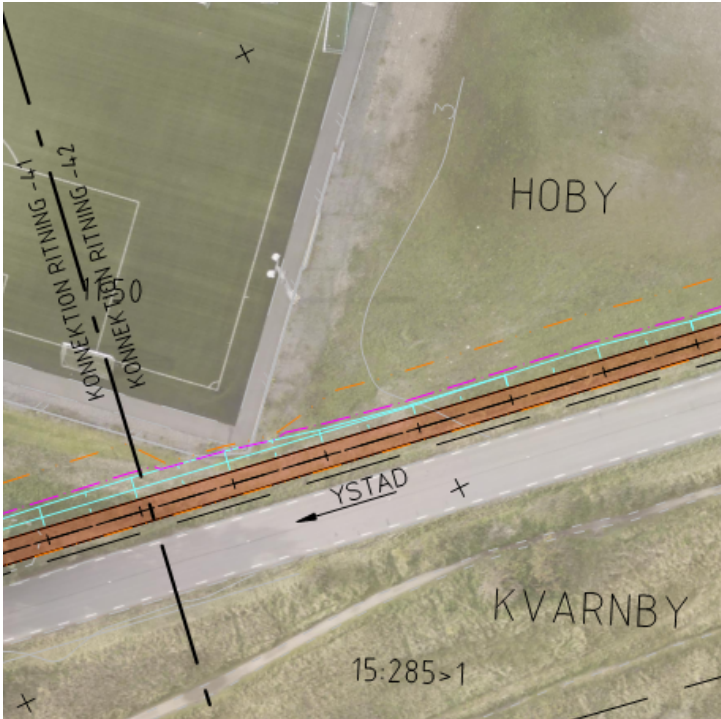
Plankarta 101T0242 efter ändring, samma ändring syns på plankarta 101T0241
